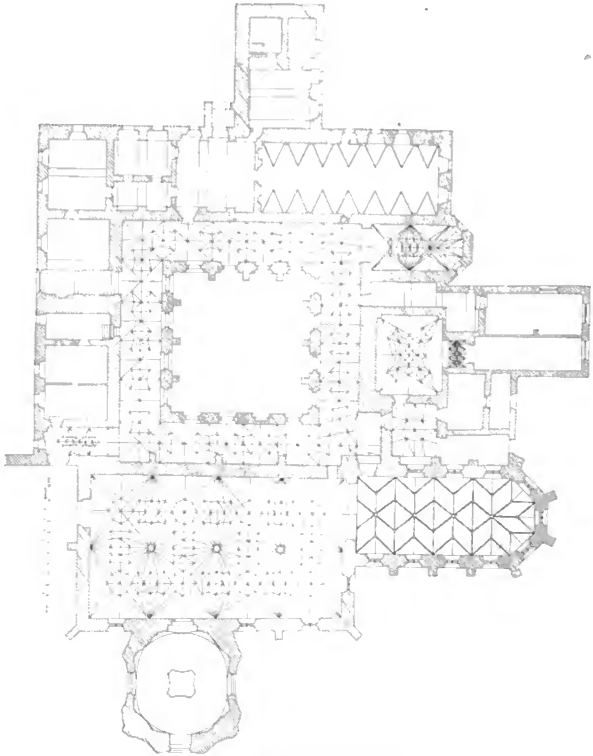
Bechin. Grundriss des Klosters.
